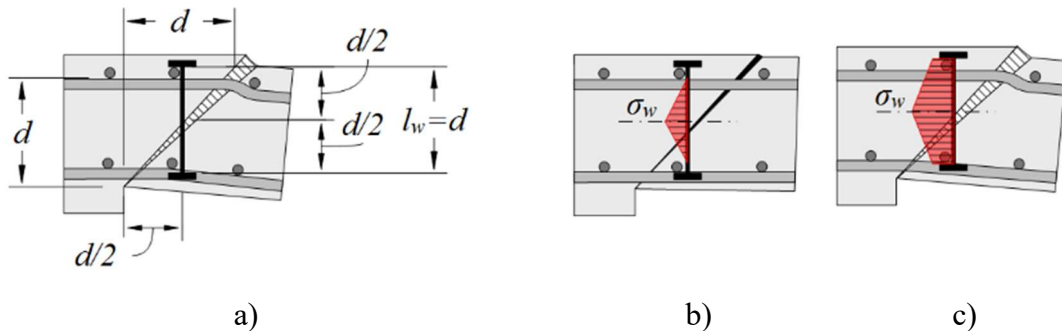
Tensão na armadura de cisalhamento como função da abertura de fissura (adaptado de LIPS, 2012)
